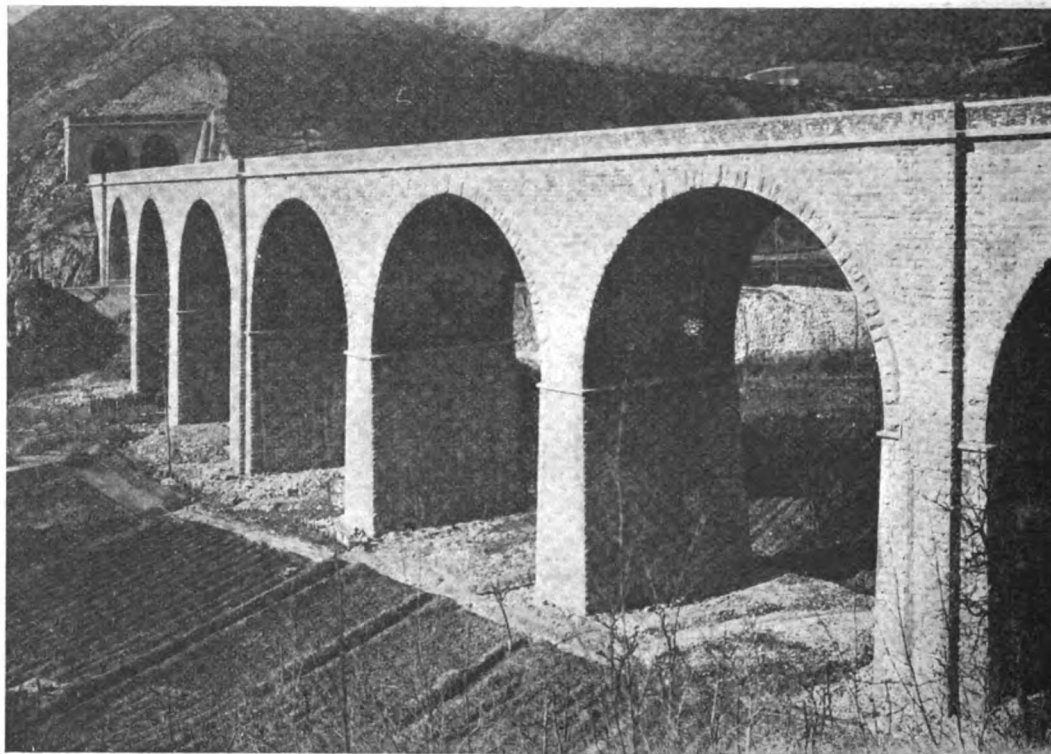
Viadotto Meschio. Particolare con l'imbocco Pont'Alpi della Galleria Col Bastianon.
